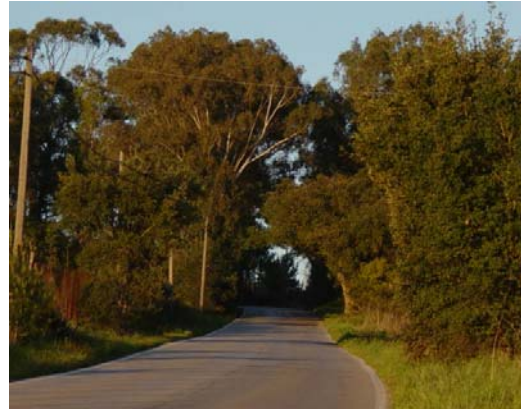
Área de localização das maiores escavações do traçado (15 metros, km20+850)
